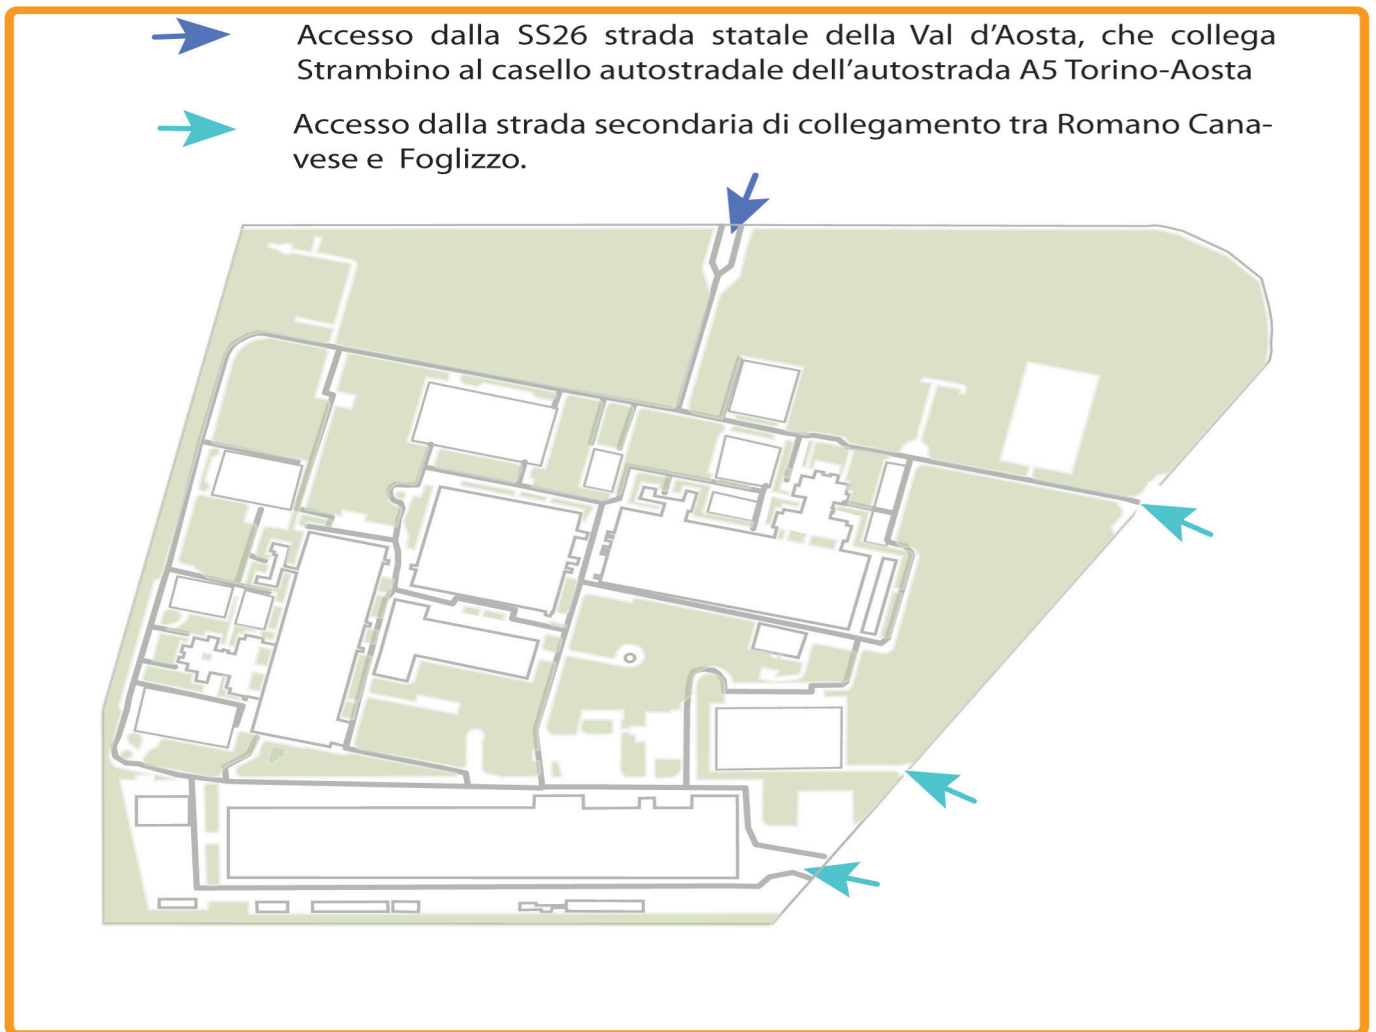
Planimetria degli accessi dello stabilimento ex-Olivetti di Scarmagno
